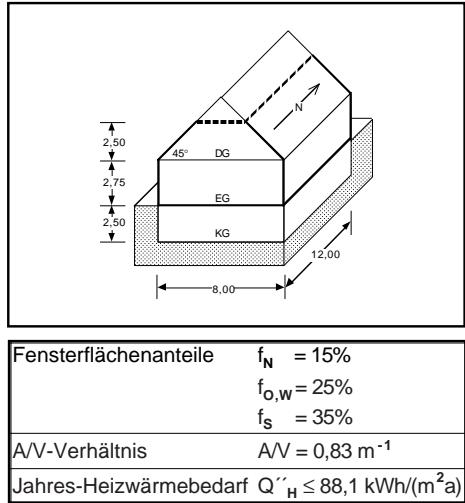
Beschreibung des zugrunde gelegten freistehenden Einfamilienhauses.
